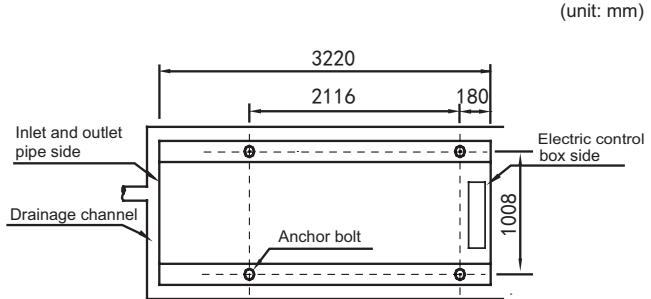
Vista dall'alto dello schema delle dimensioni di installazione dell'unità KEM-90 DNS3
